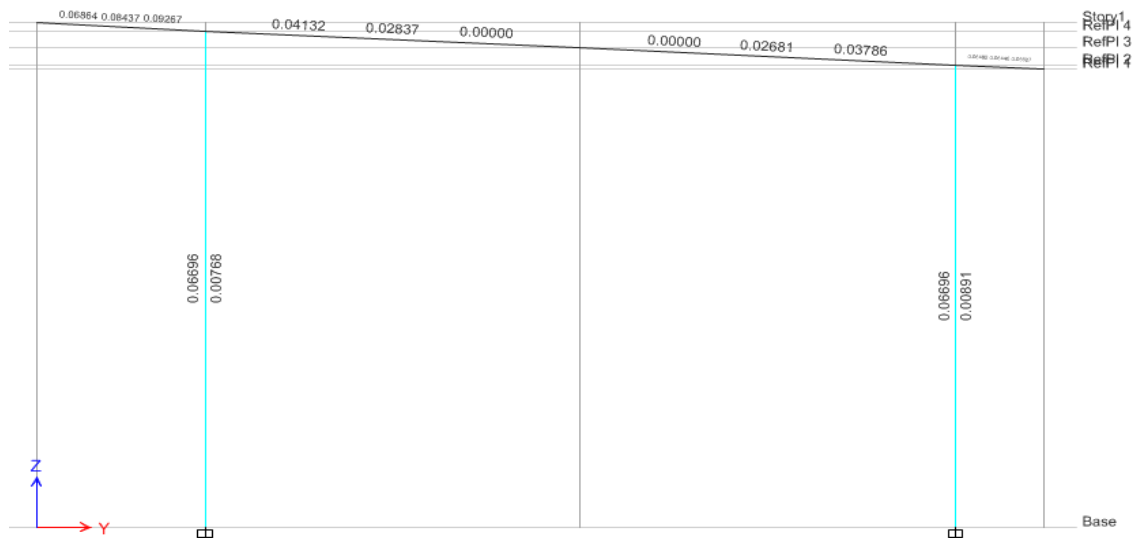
Área de acero por corte de viga (25X60) de Módulo IV
